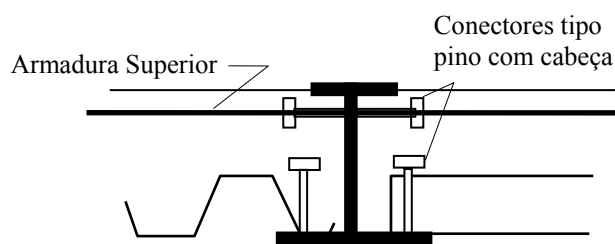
Detalhe típico da ligação laje-viga metálica do sistema de piso esbelto
